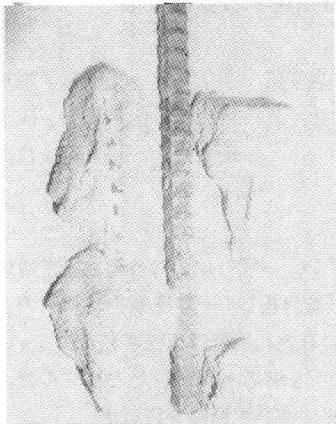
鉄筋の離脱状況 [Case1] 写真-2 表面のひびわれ状況
